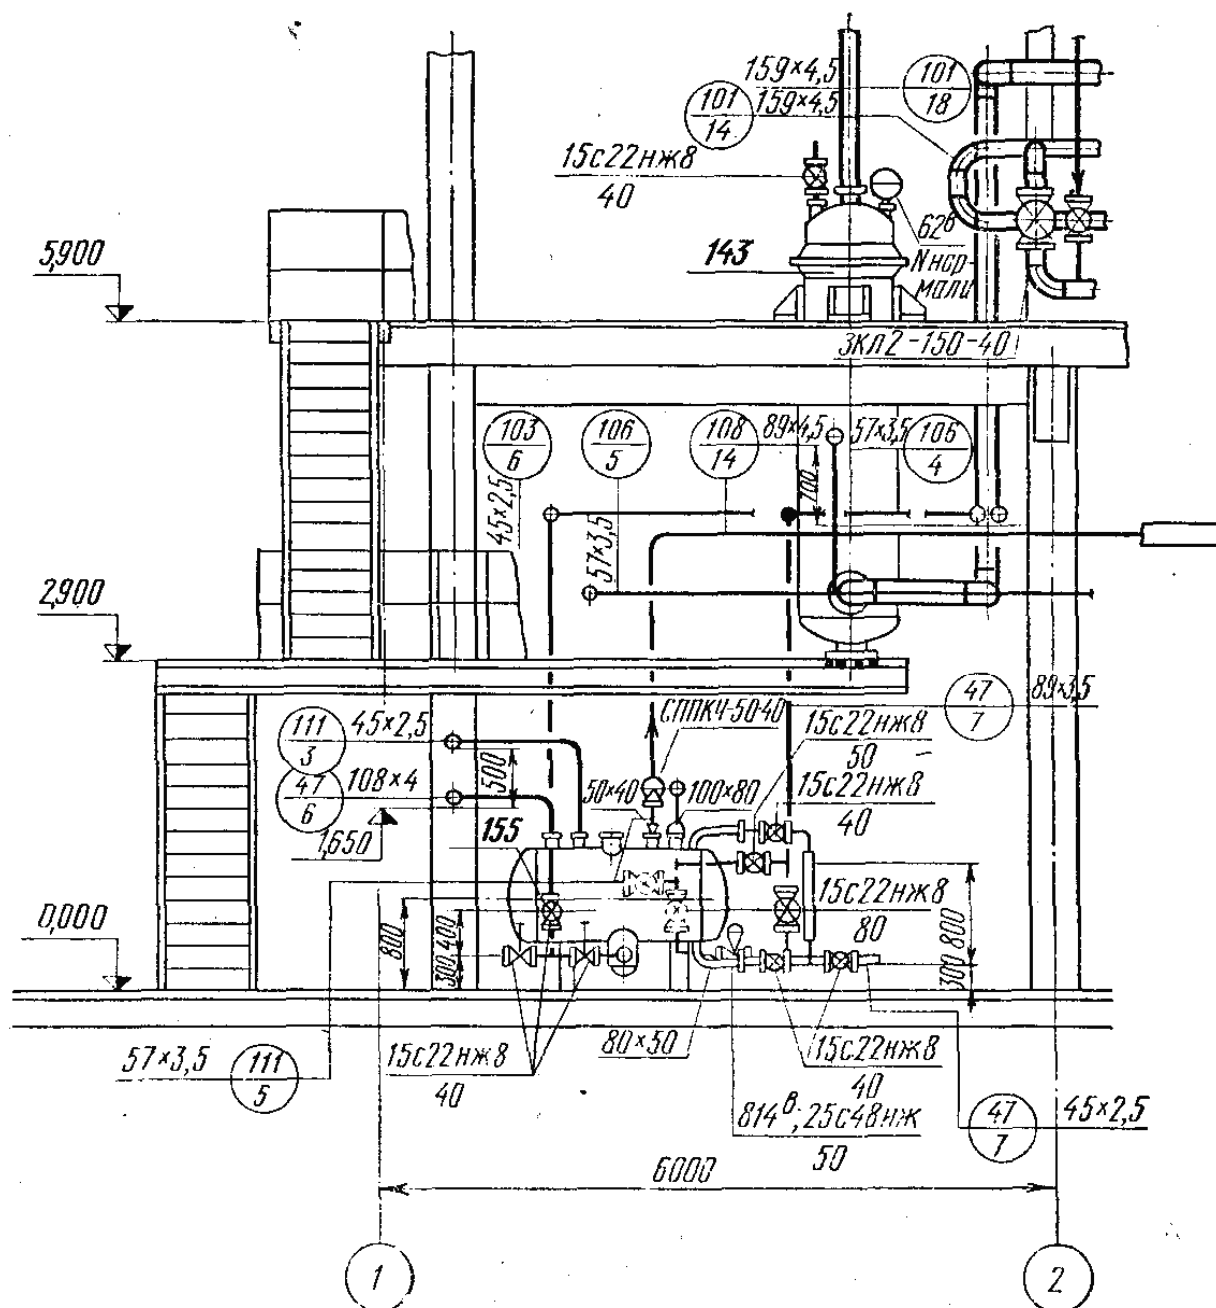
Монтажный чертеж (разрез) внутрицехового трубопровода
